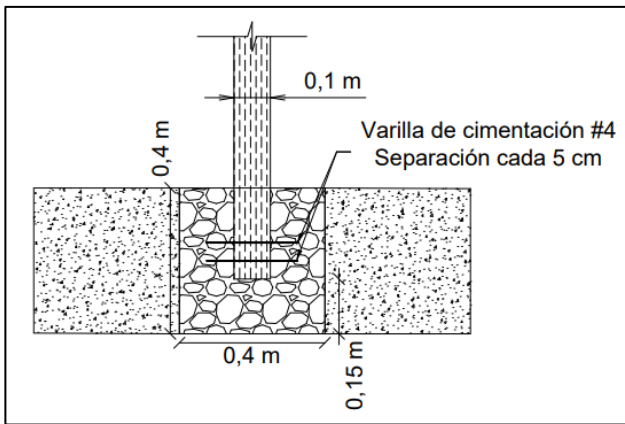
Propuesta de anclaje de sobrecimiento con estructura de muros con varilla roscada
